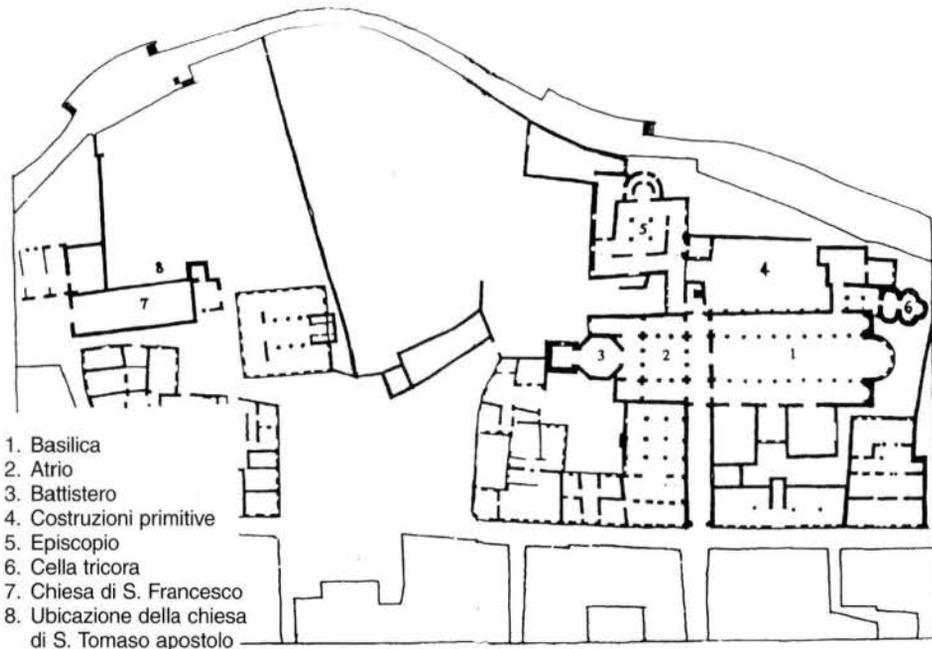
Pianta dell'area settentrionale di Parenzo (foto Tereza Pavlović).
